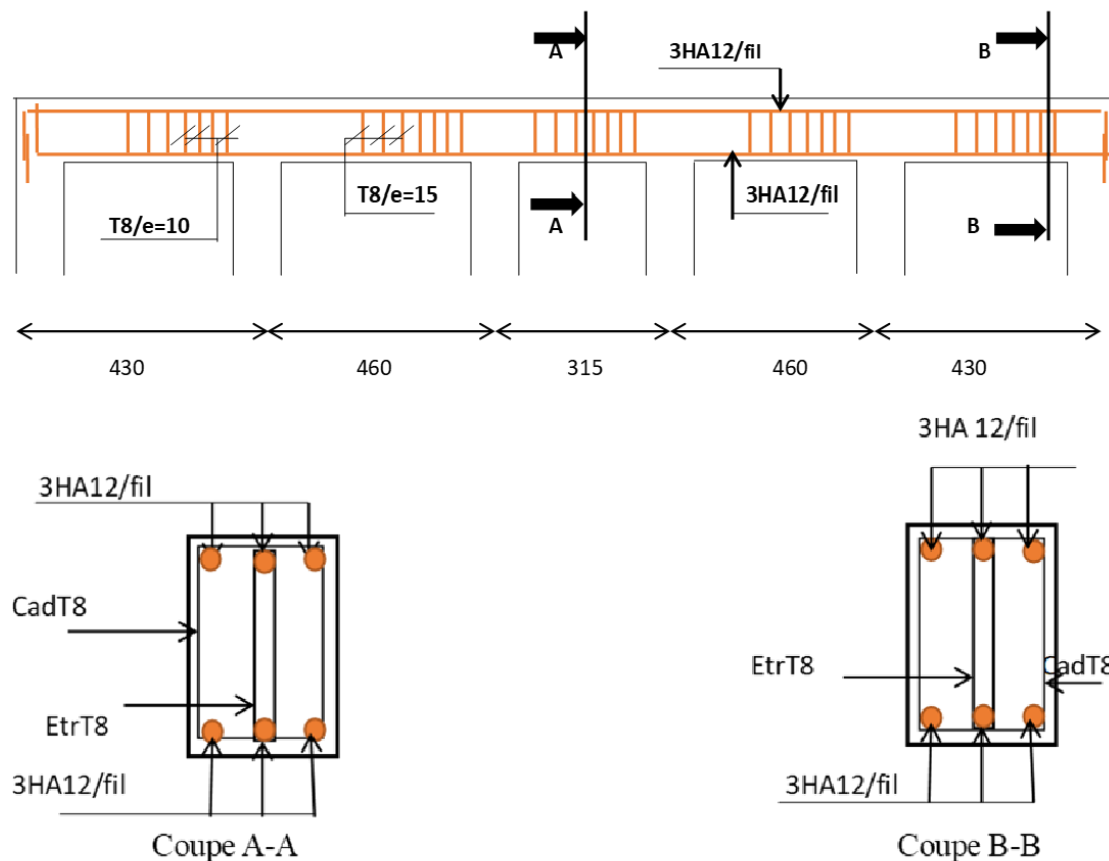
Schéma de ferrailage d'une poutre principale
